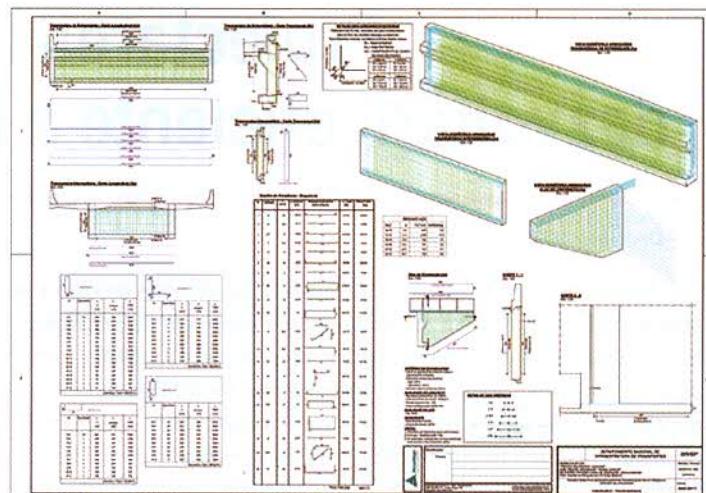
Plan armare ziduri întoarse în „Allplan Inginierie”
